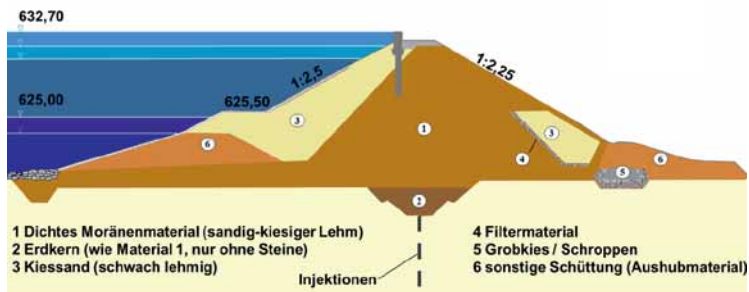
Dammquerschnitt des Windachspeichers (WWA Weilheim)
